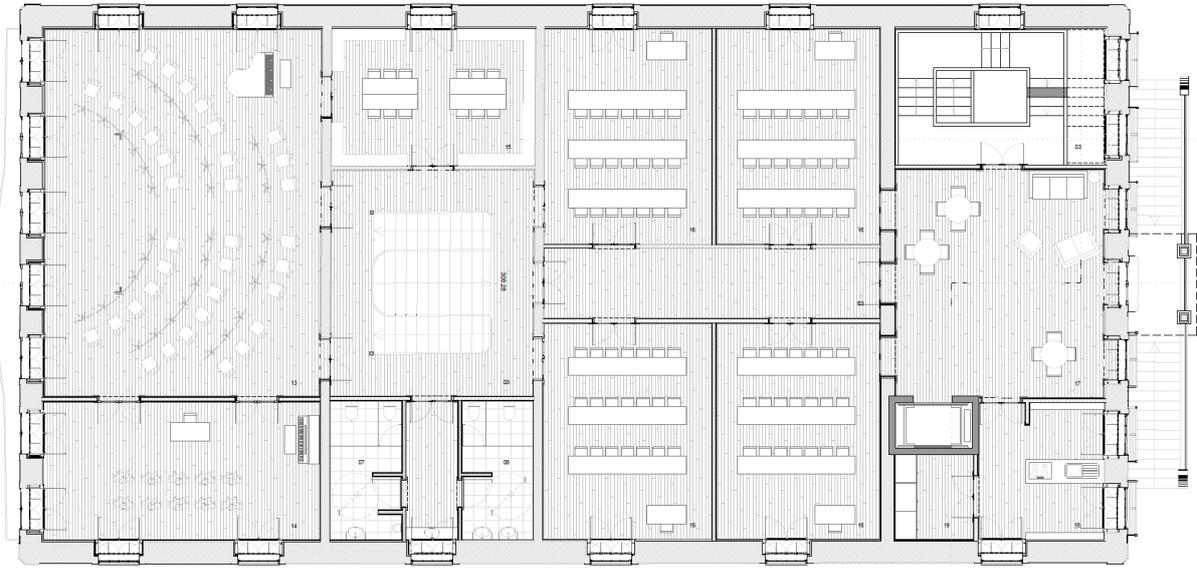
Planta Piso 1, Proposta de Intervenção<sup>15</sup>
